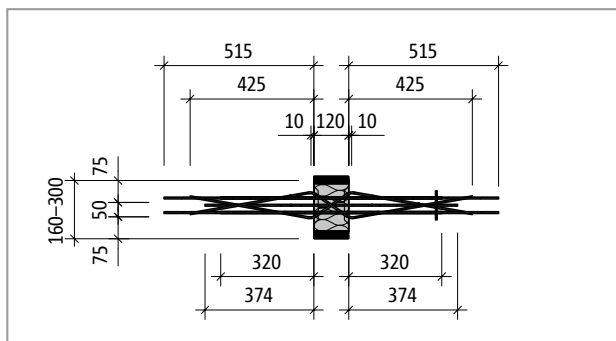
Schöck Isokorb® XT type W-M1: Product plan view
